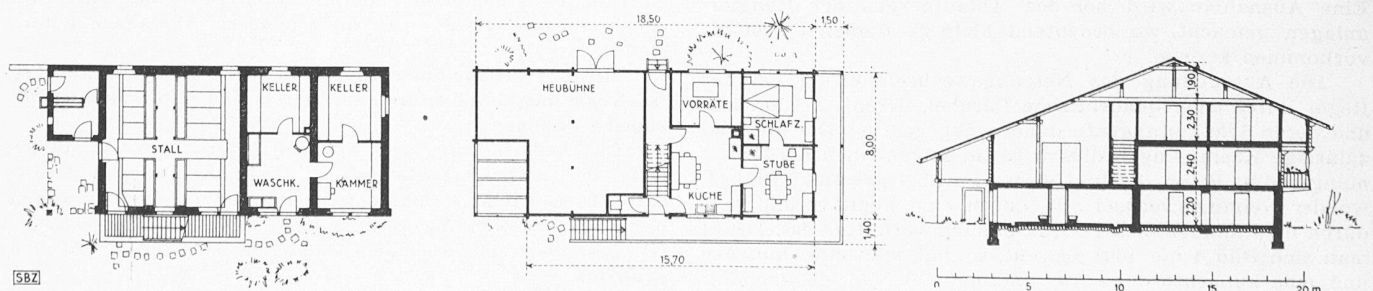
Grundrisse und Längsschnitt wie Bild 1. Masstab 1 : 400. Stall und Heubühne sind im linken Teil des Hauses untergebracht, die Wohnräume befinden sich rechts
